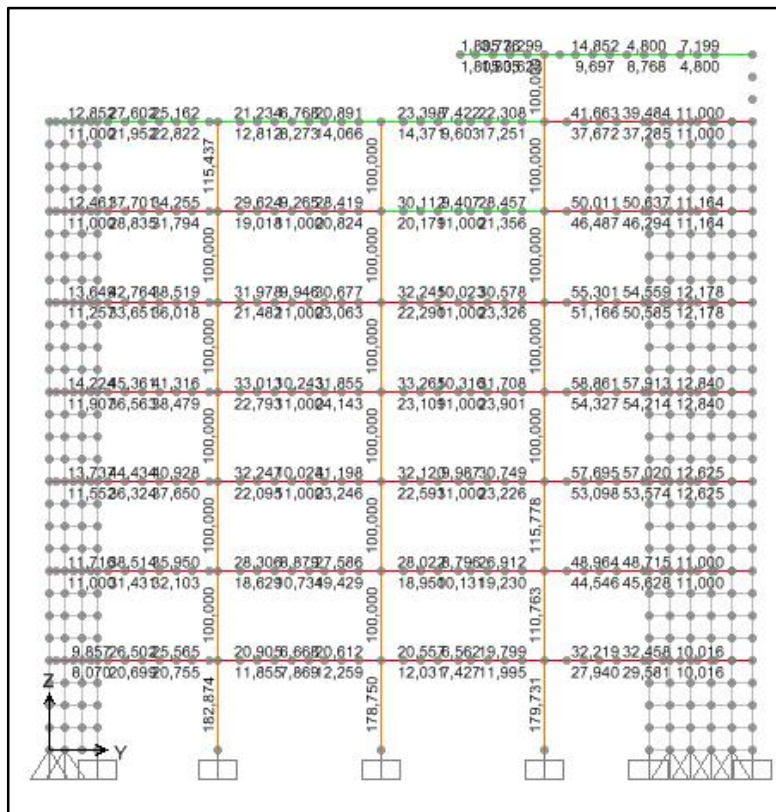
Acero en vigas pórtico 8, Hall Central
